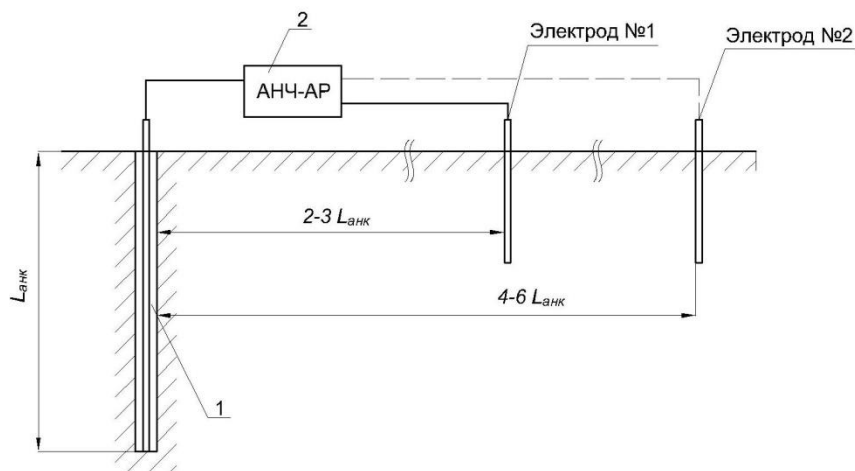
Схема установки оборудования для осуществления контроля качества установки железобетонной анкерной крепи: 1 – железобетонный анкер; 2 – электроизмерительный прибор; $L_{анк}$ – длина анкера, м.
